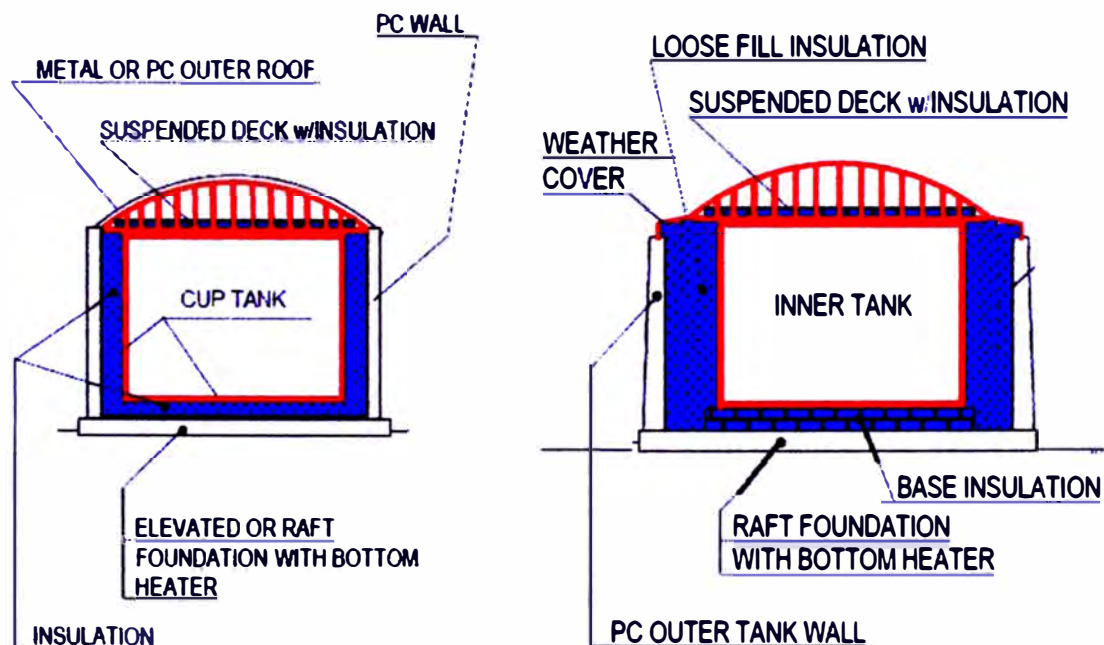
FIGURA (f) TANQUE DE PARED SIMPLE + TK HORMIGÓN FIGURA (g) TANQUE PARED SIMPLE TK HORMIGÓN AISLADO
